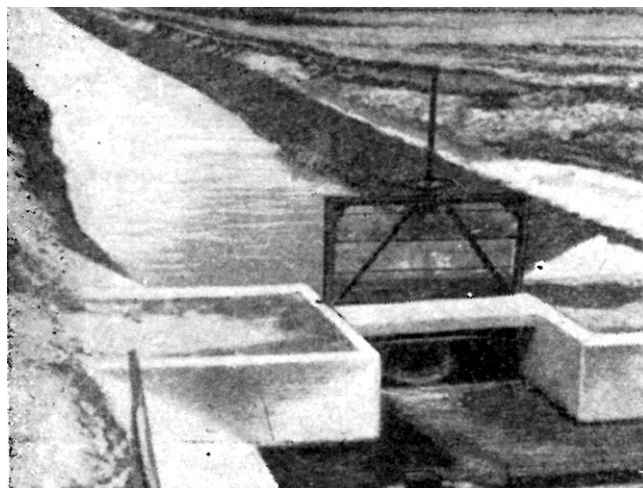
Stăvilar de beton pe canalul Iazul Morilor-Buzău
